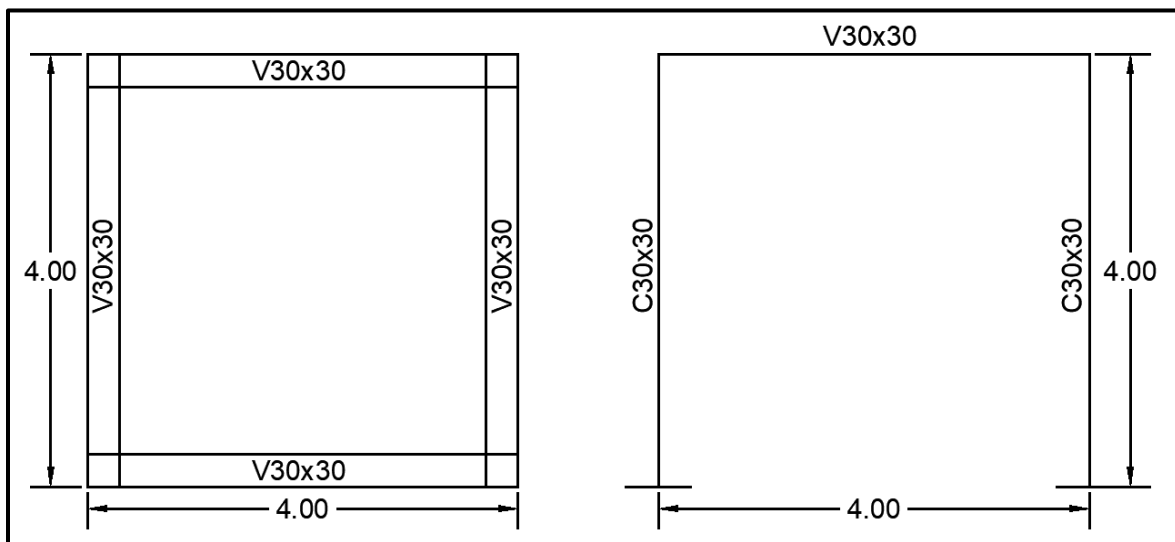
Planta y elevación de sistema 1 nivel. Fuente: Elaboración Propia
